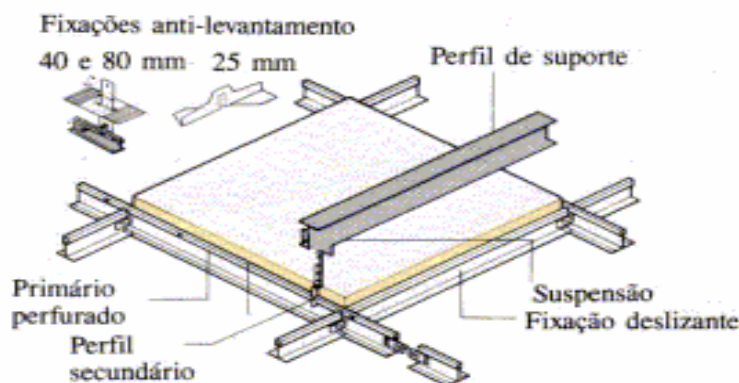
Perfilaria à vista de tectos falsos com painéis em lã de rocha.
